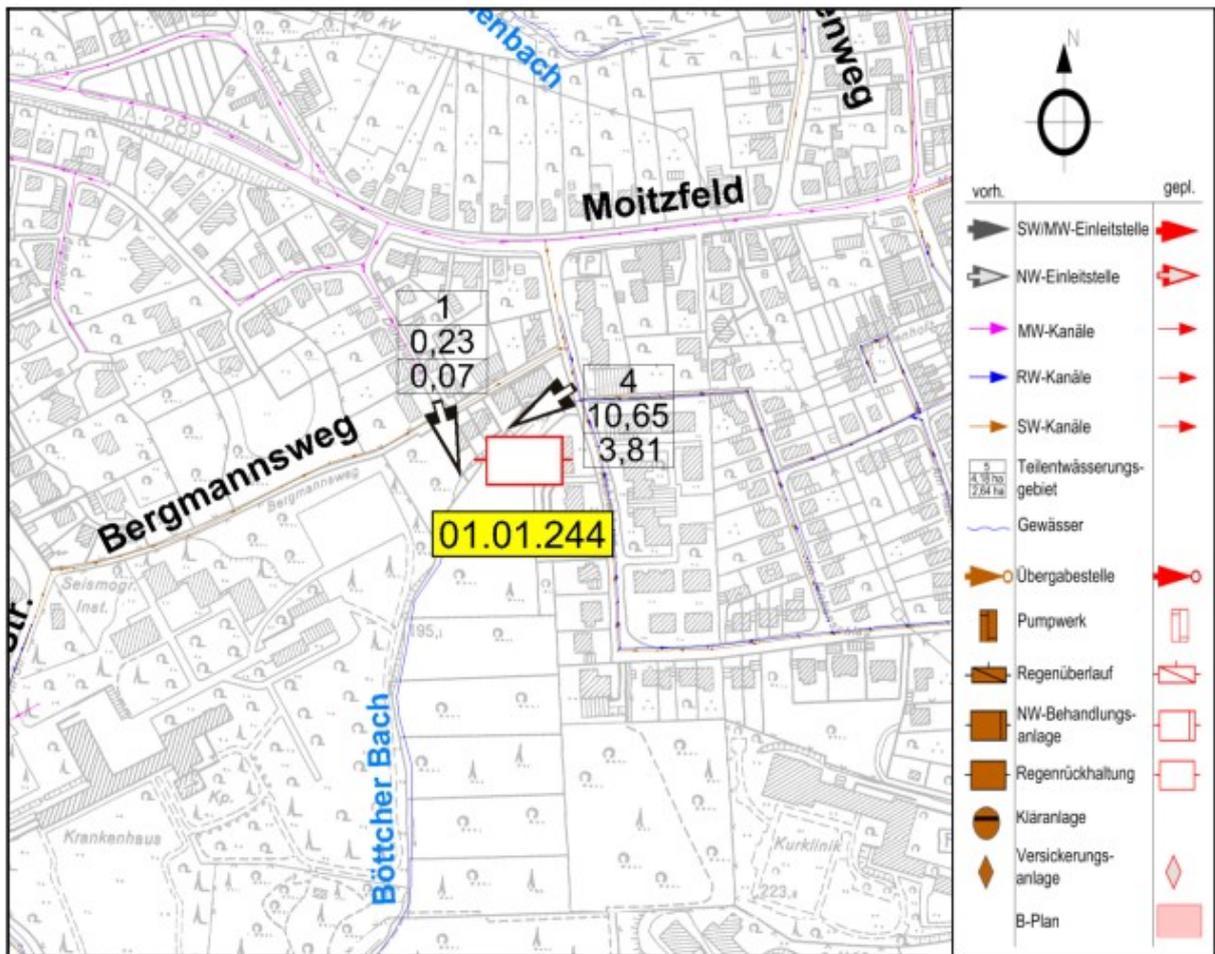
Auszug aus Lageplan (unmaßstäbliche Darstellung)
